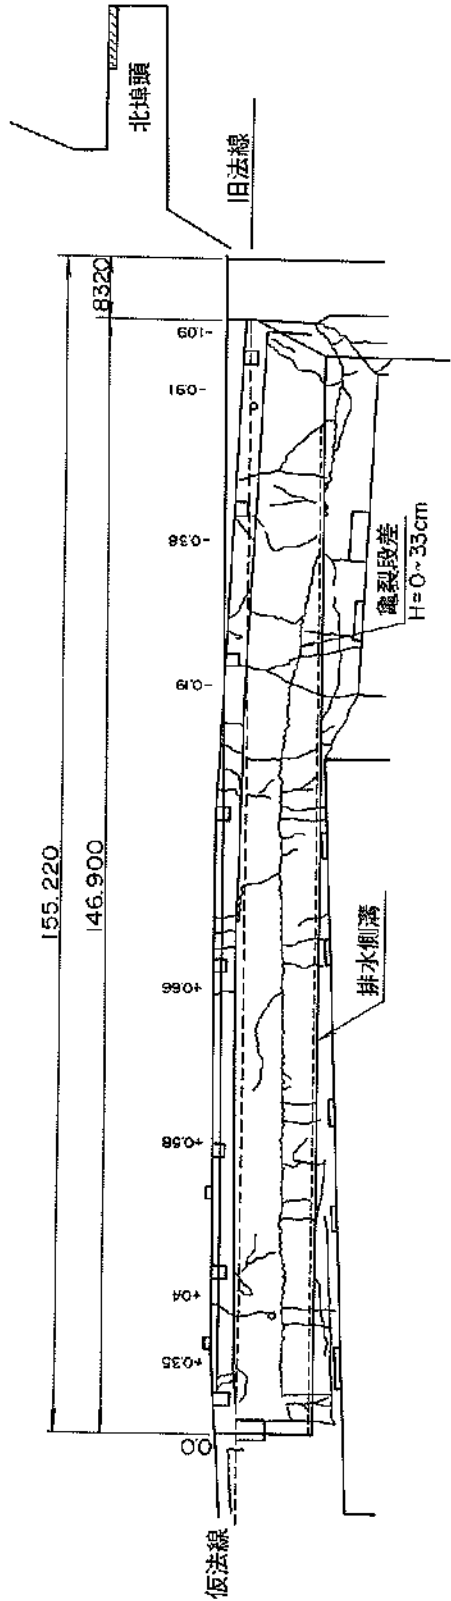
エプロンラック平面図 (北埠頭, ②東岸壁 (-8.1m))
